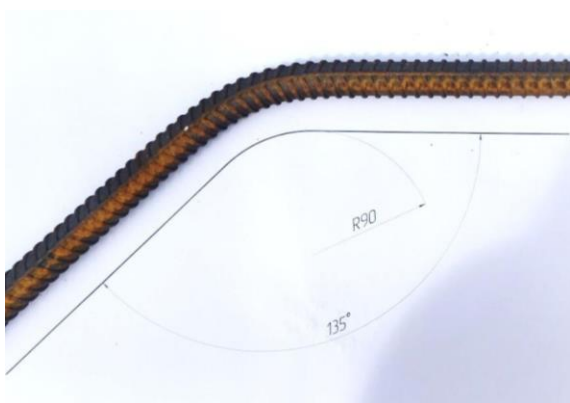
Опытный образец с радиусом загиба 90 мм и углом загиба 135°
